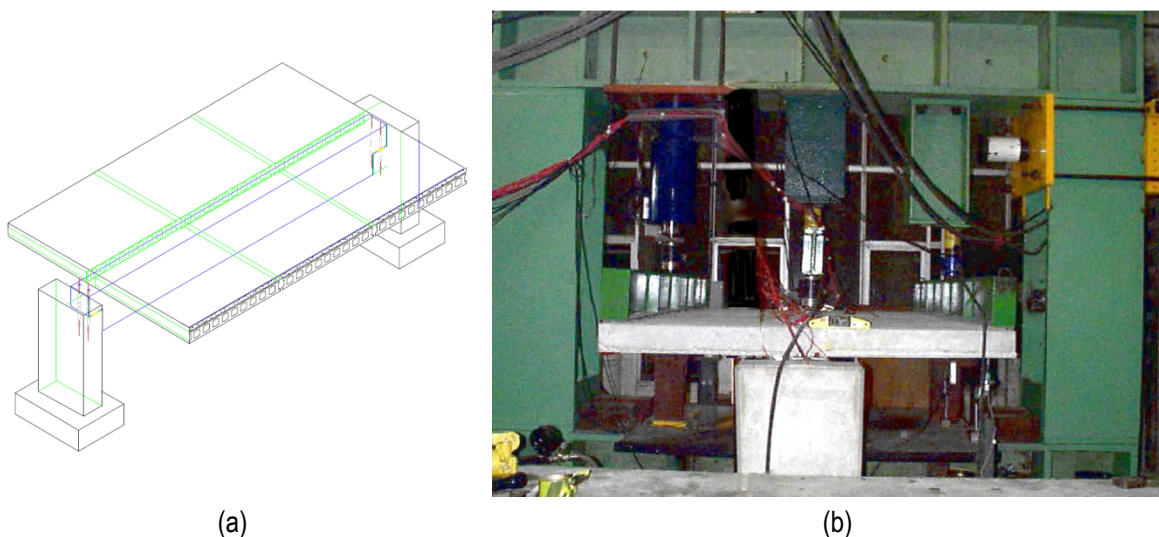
Ensaio de lajes alveolares com continuidade por preenchimento dos alvéolos, realizados por BARBIERI e GASTAL (1999).
